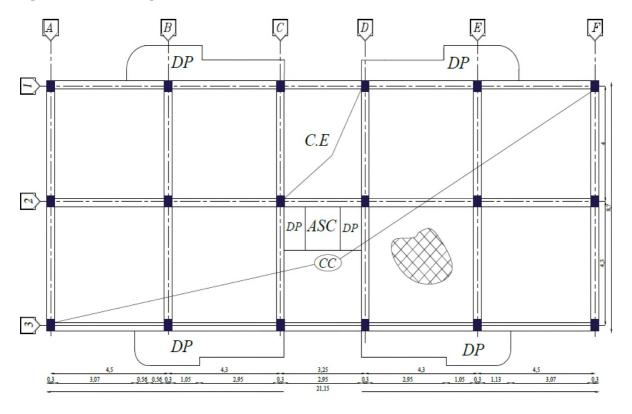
plans de coffrage du plancher étage courant (corps creux- dalle pleine)
